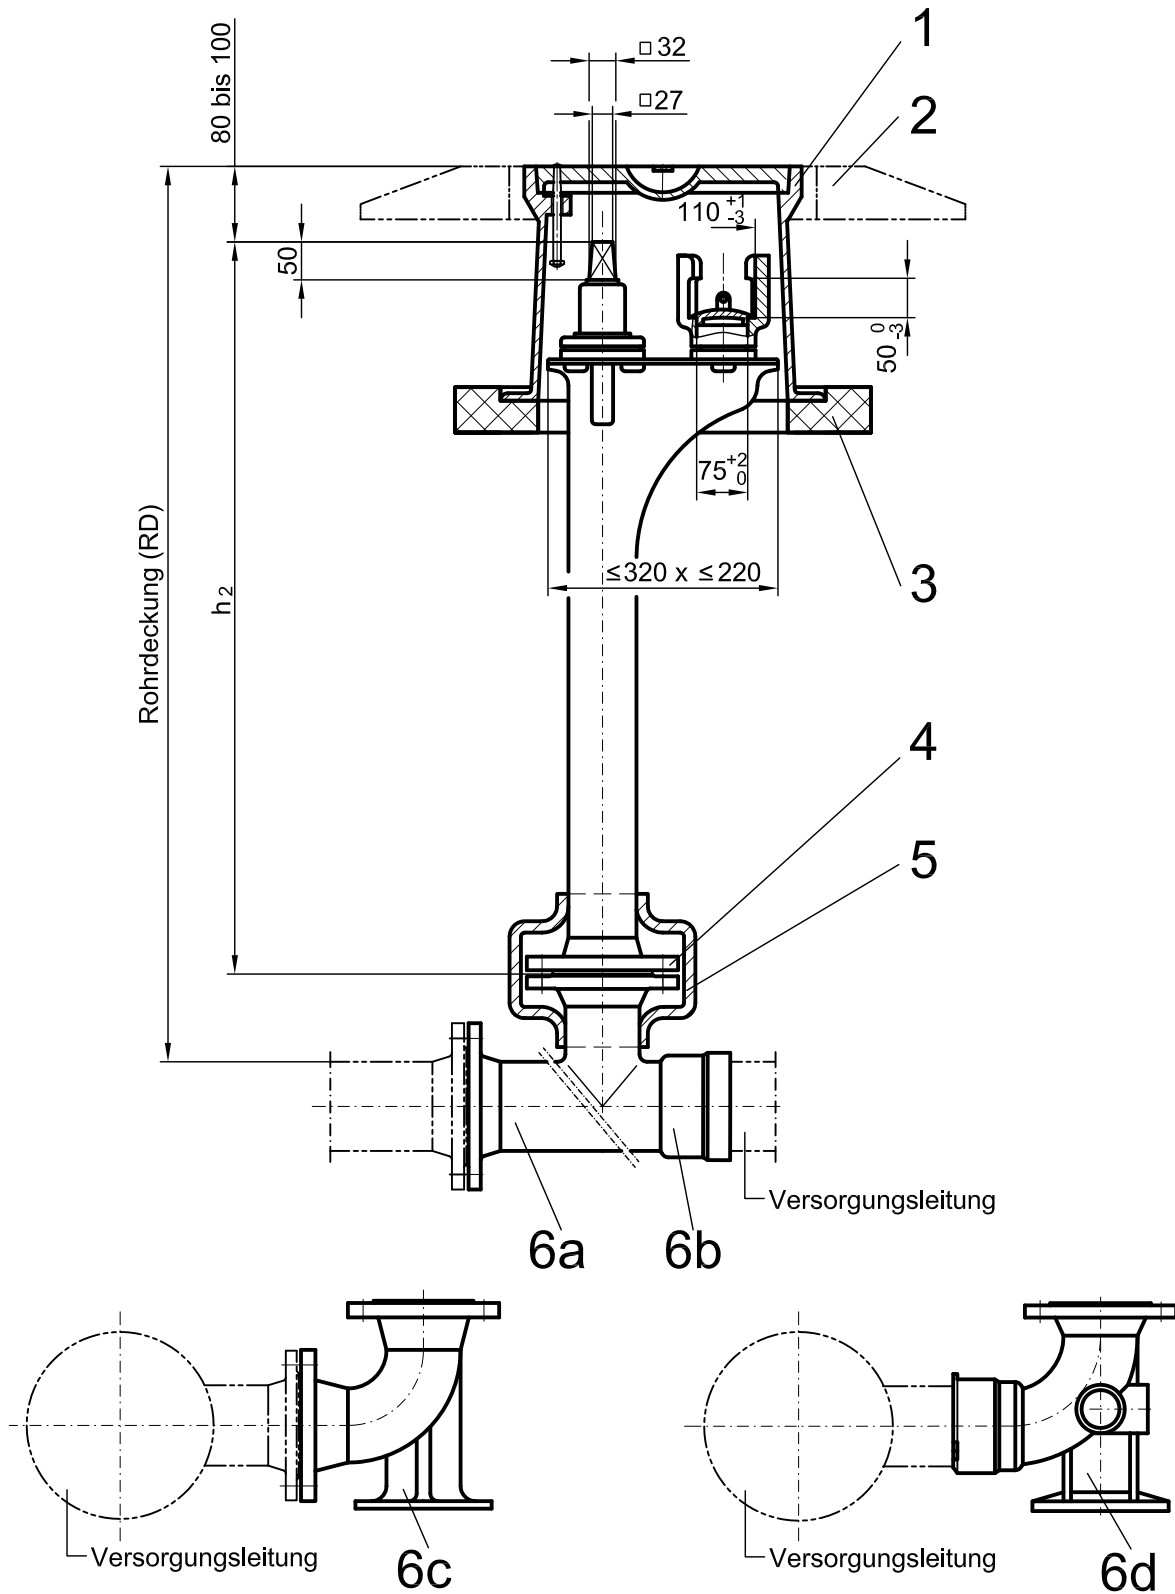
Hydrant DN 80 mit unterem Anschluss – Darstellung Typ A 1 einschließlich der Darstellung der möglichen Anschlussarten (wahlweise) nach DIN 3221:1986-01 (zurückgezogen) (Prinzipskizze)
